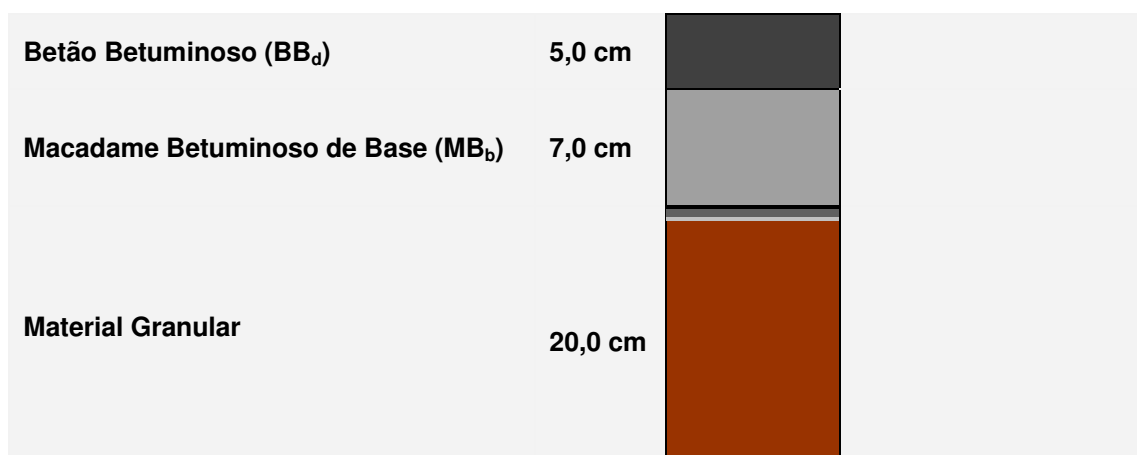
Estrutura Pavimento Final nos Locais com Fundação Aceitável
